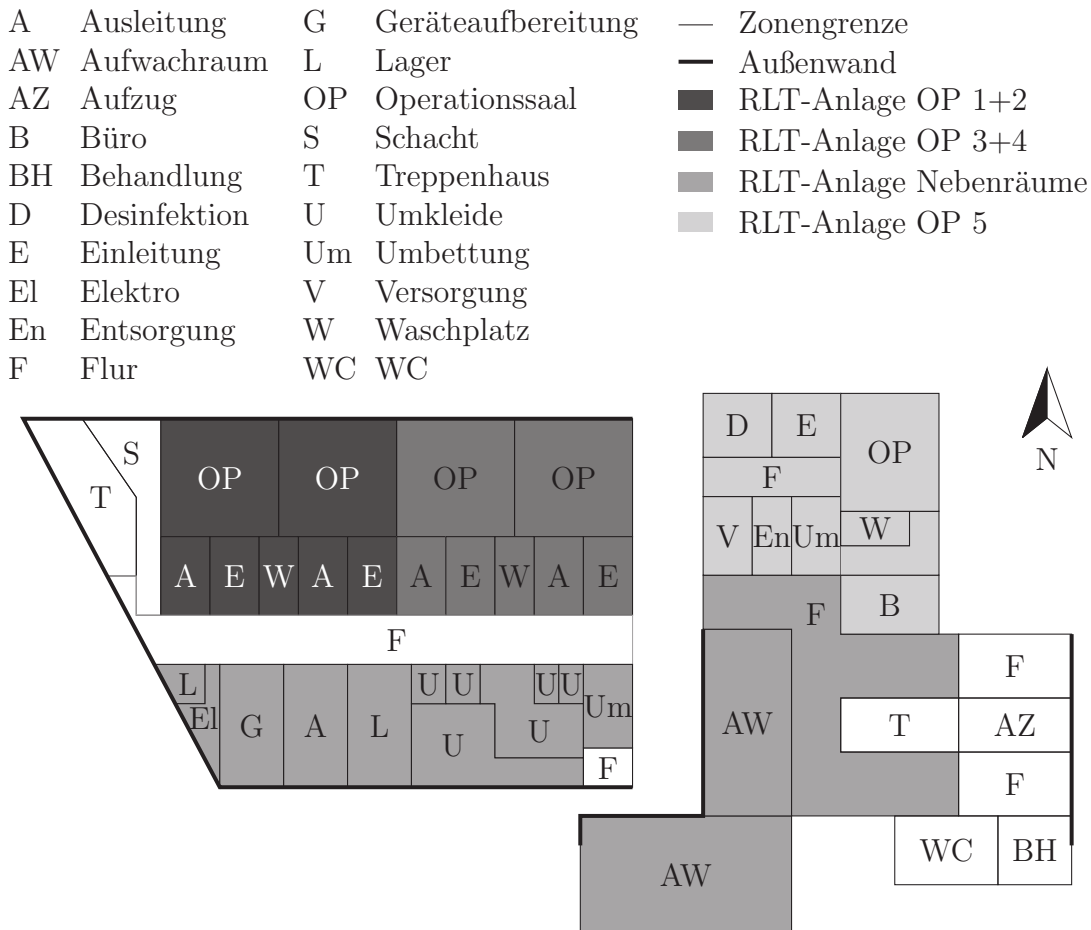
Grundriss der beiden OP-Stationen
